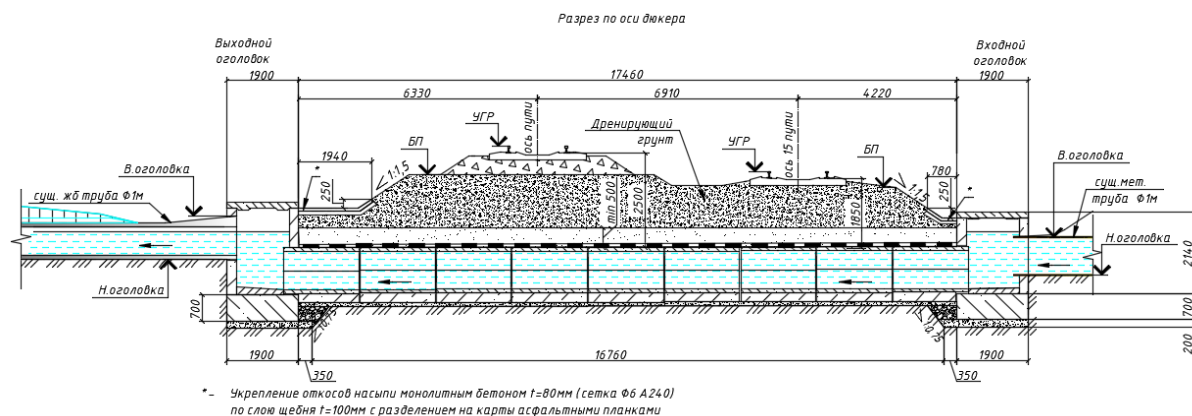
Конструкция железобетонного дюкера (разработан автором)
